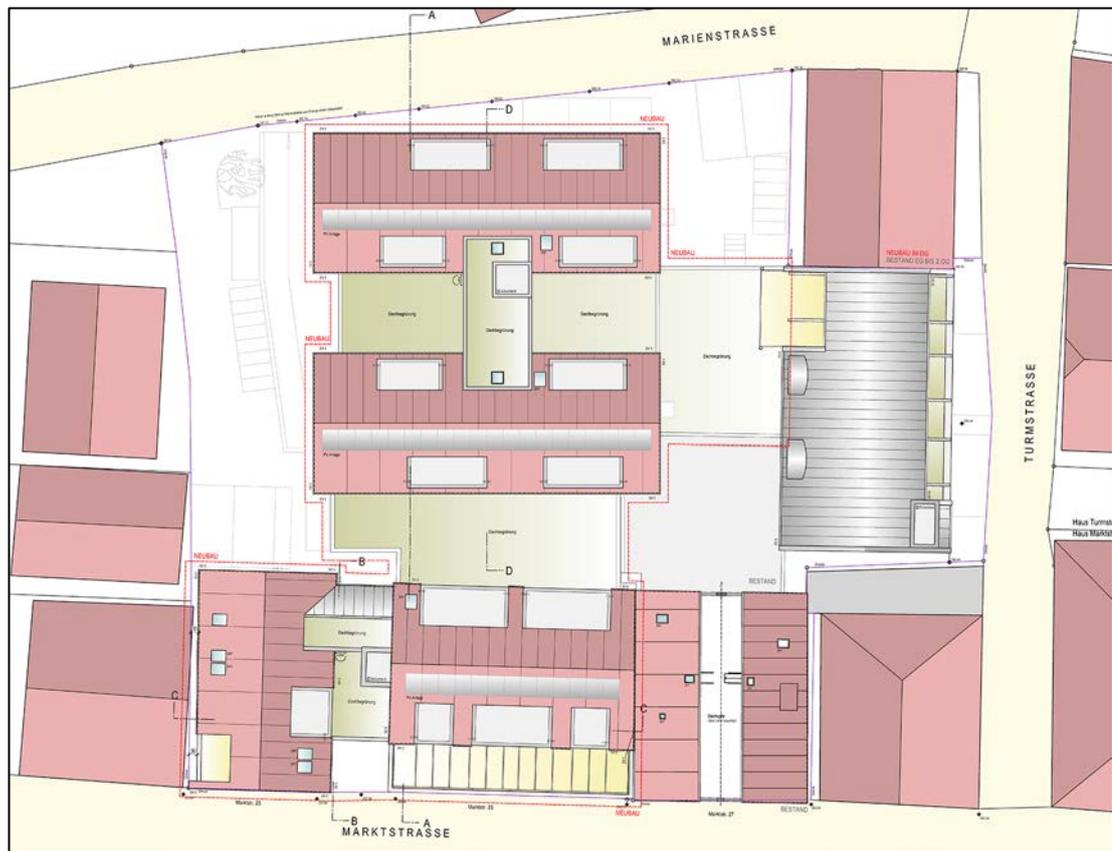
Lageplan Objektplanung Gebäude (Entwurf), Dachaufsicht, Stand 26.05.2022
